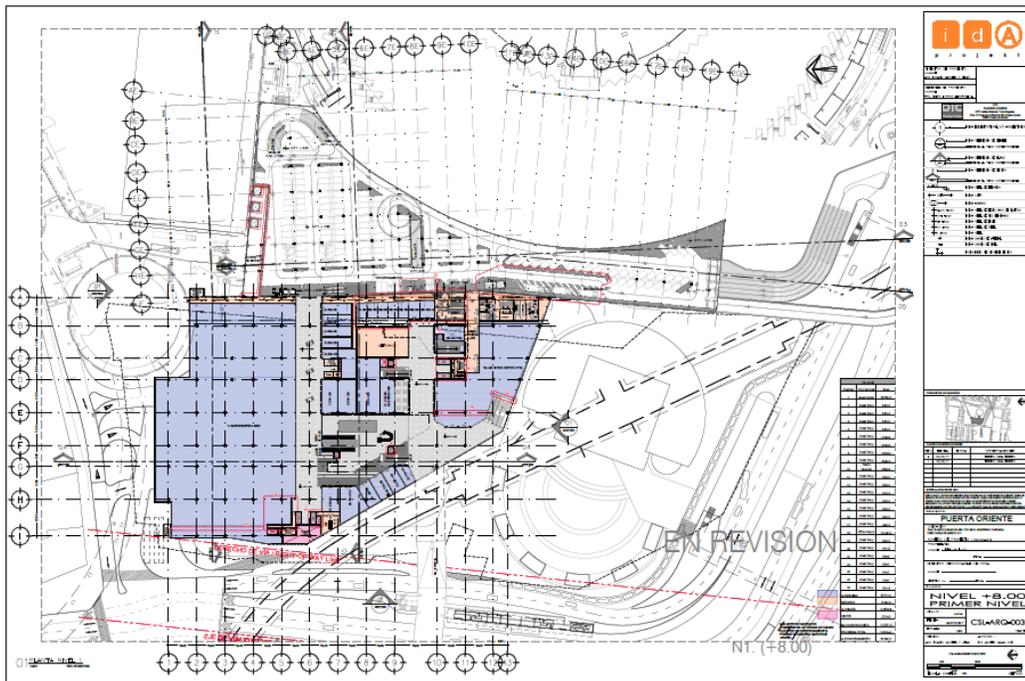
Nivel Planta Baja (+8.00). Fuente: Puerta Oriente por IDA Projekt.
